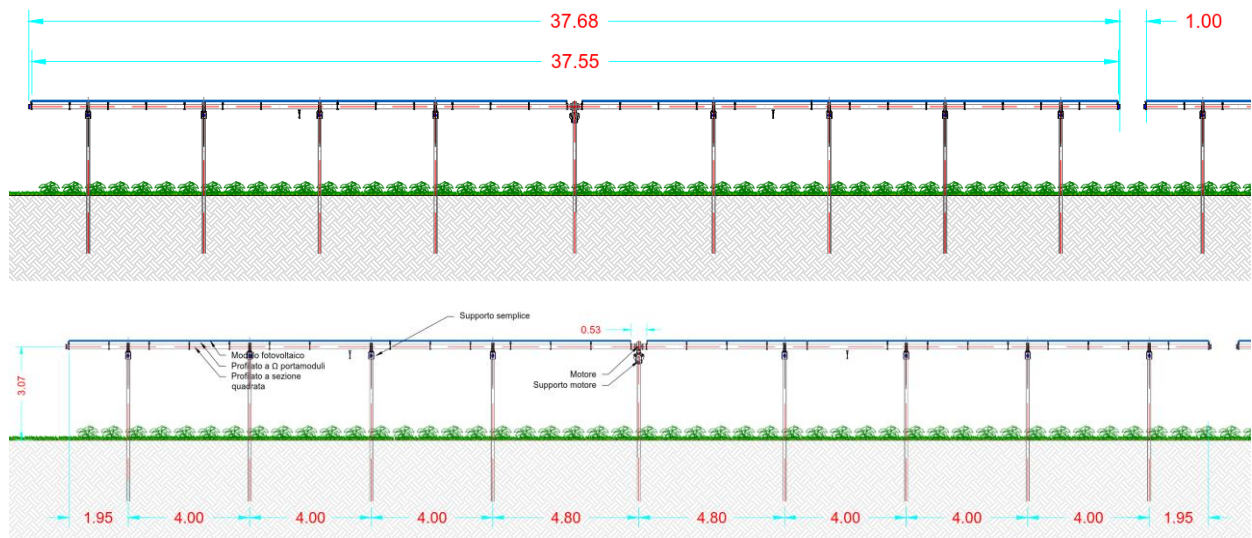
Sezione longitudinale tipologica struttura Tracker 14x1
